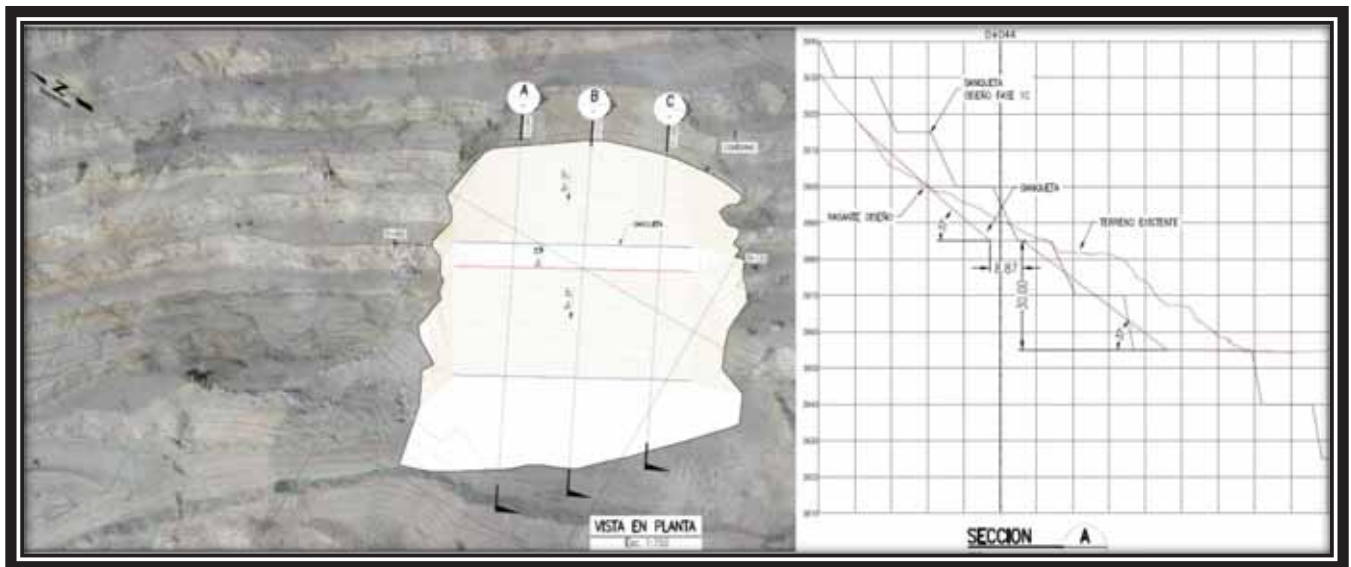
Planta sección para remediación por deslizamiento de banquetas, tajo Ferrobamba (Fuente, elaboración propia.)
